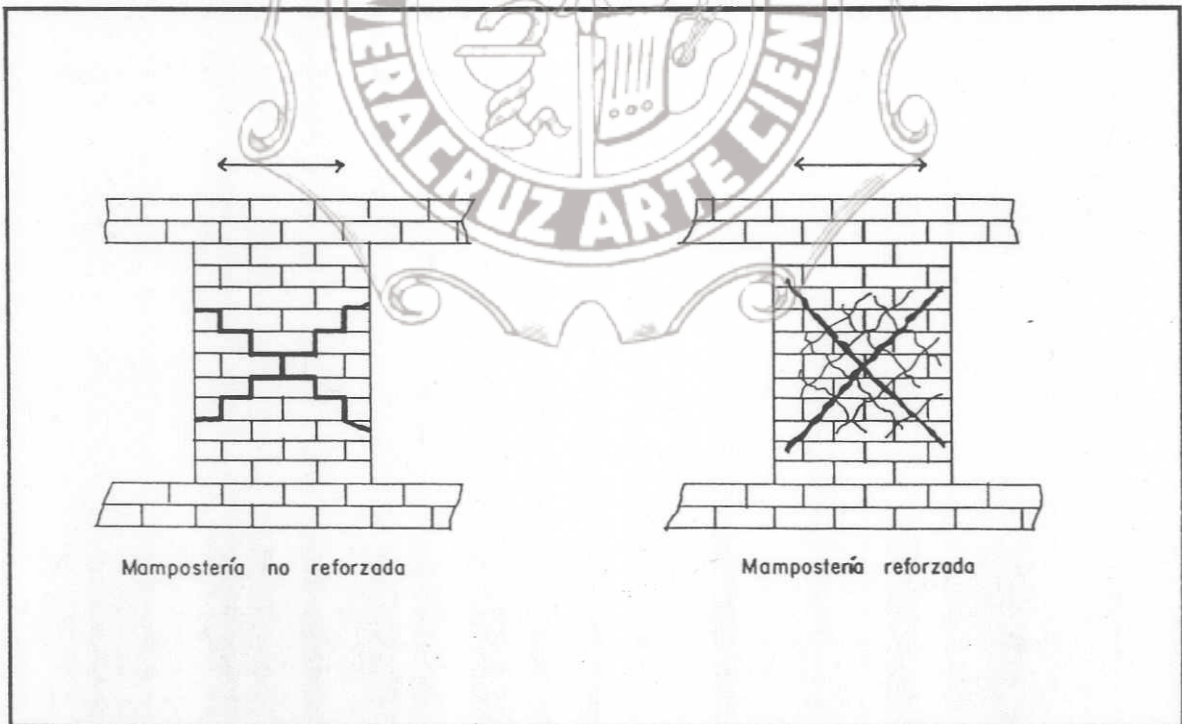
Desarrollo del agrietamiento en mamposterías reforzadas y no reforzadas bajo cargas en su plano.
